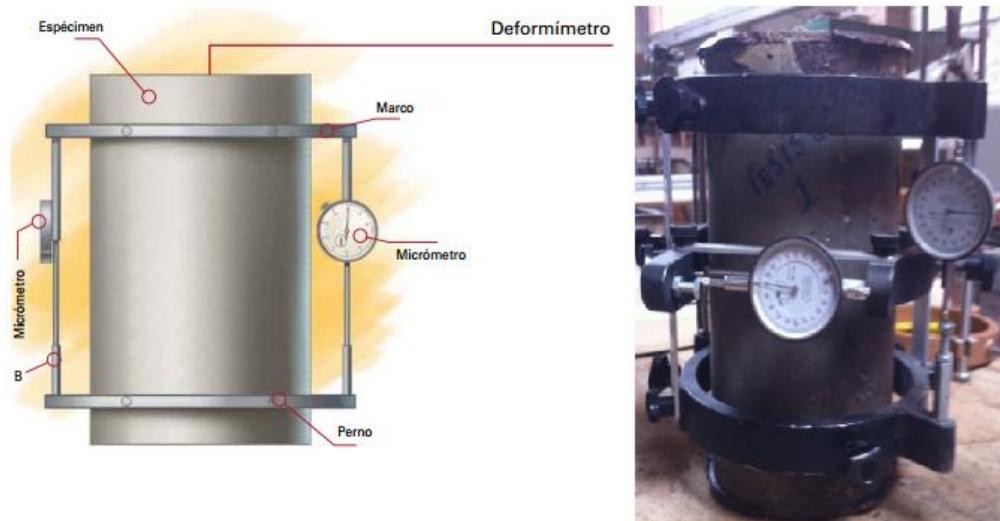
Muestra para el ensayo del módulo de Poisson
